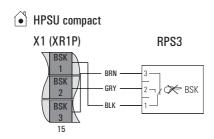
Collegamento caldaia a condensazione A1 ROTEX
